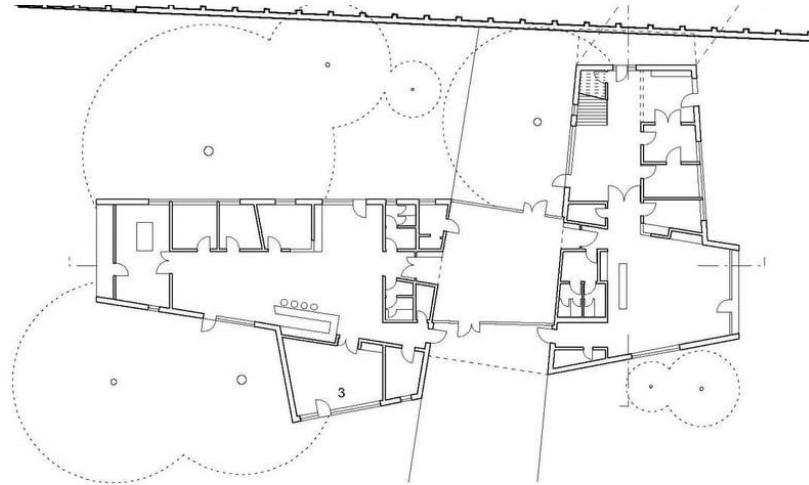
Grundriss Kinder- und Jugendzentrum Berlin
